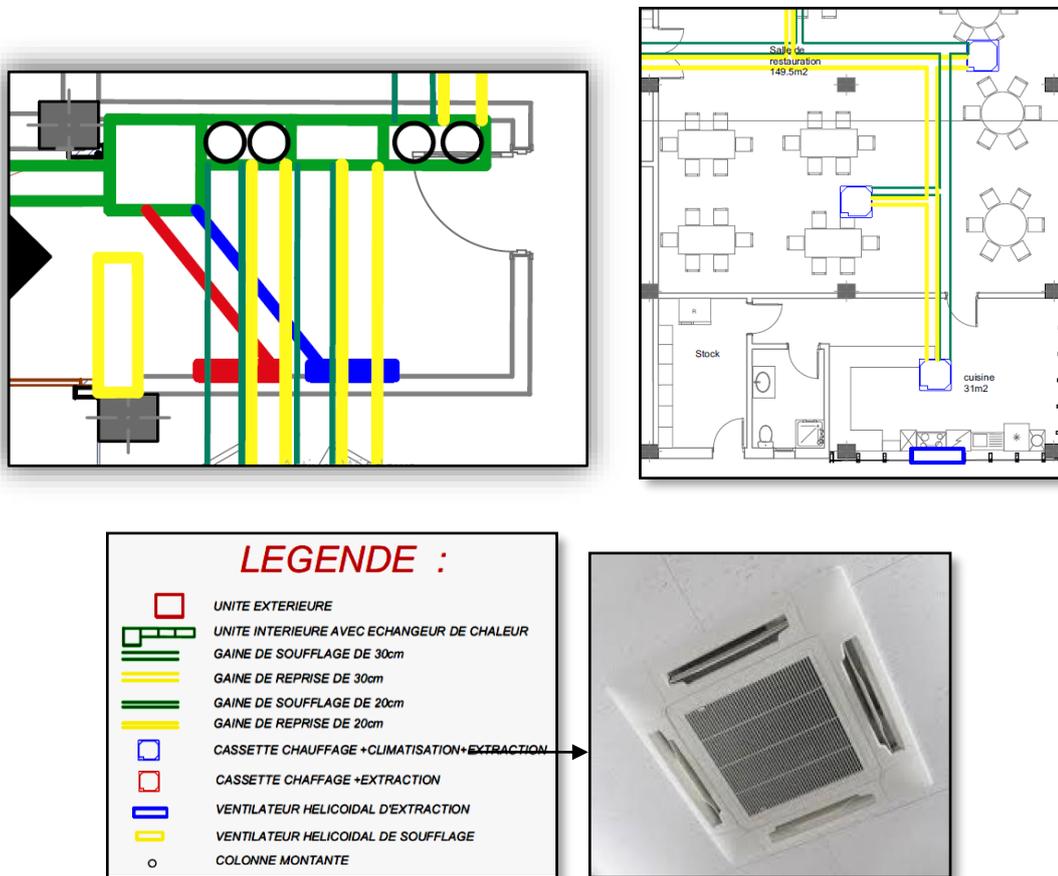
Détails local technique + Restaurant (vue en plan).¹⁴⁷
